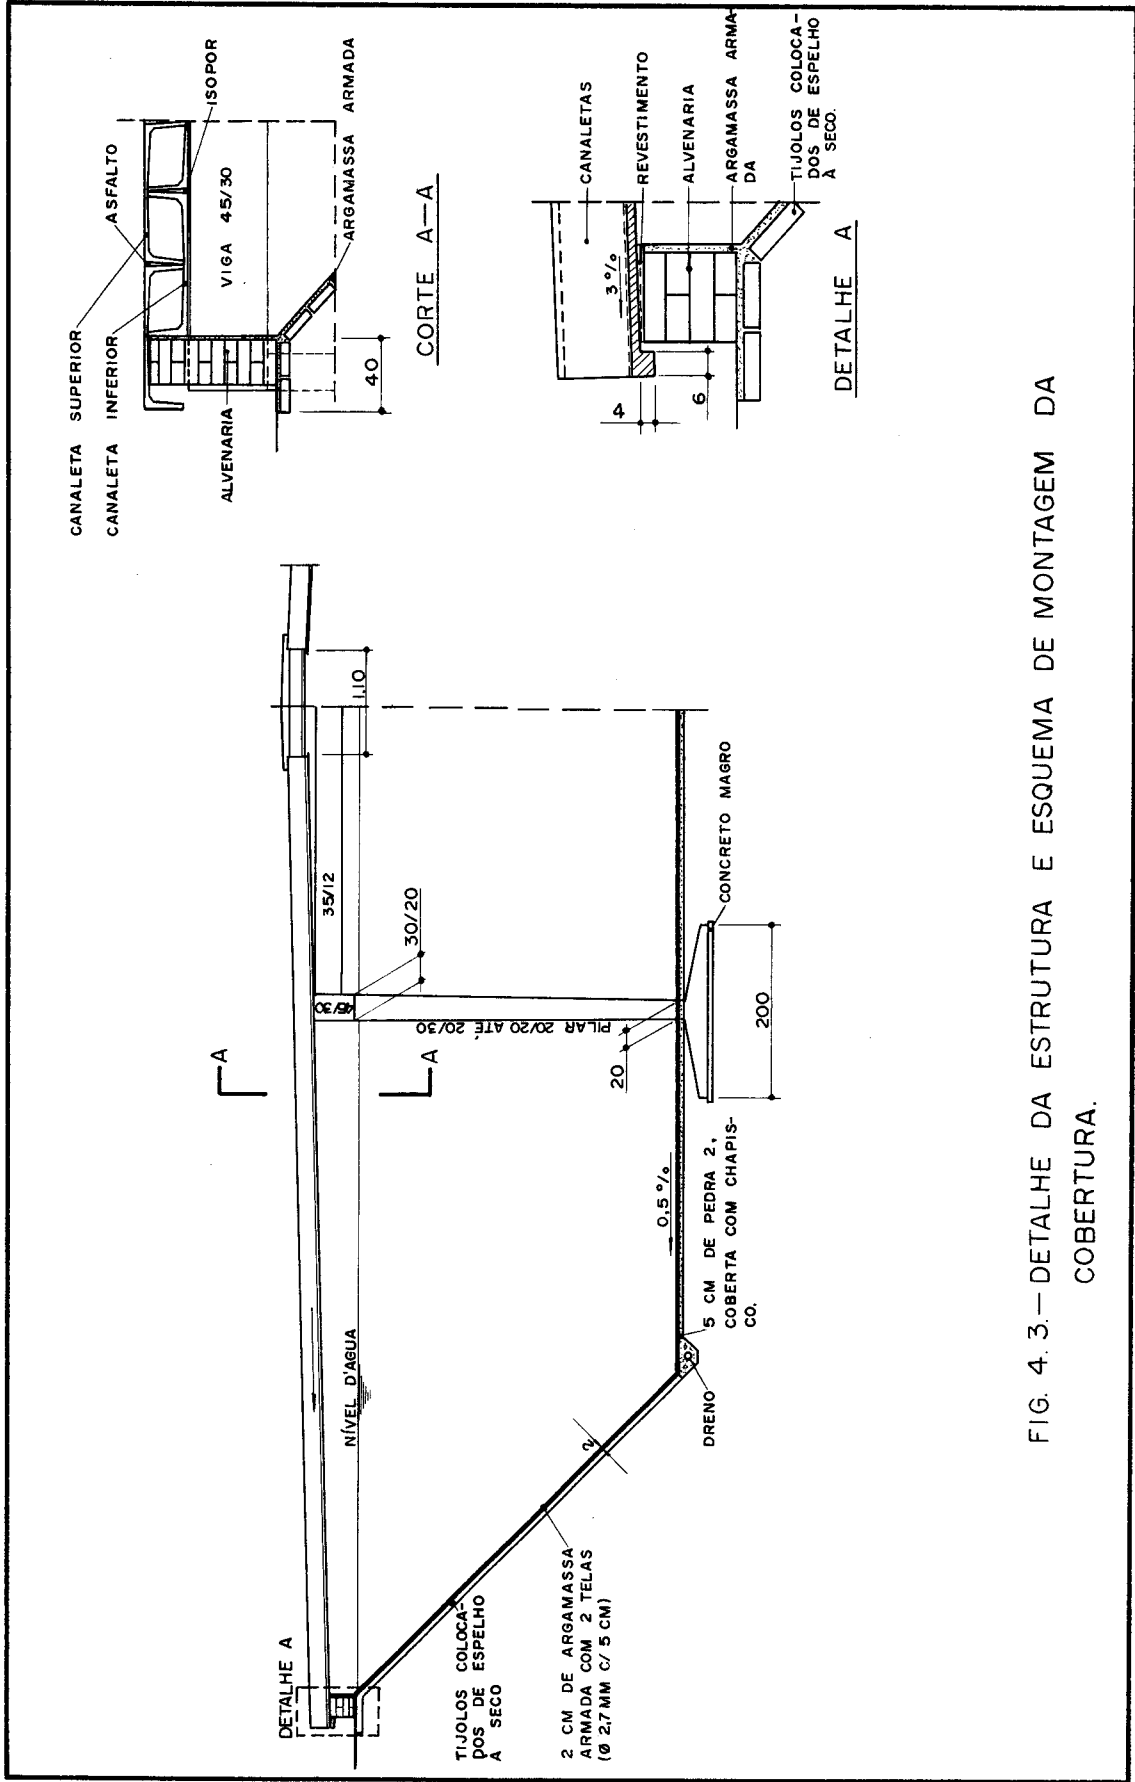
3.—DETALHE DA ESTRUTURA E ESQUEMA DE MONTAGEM DA COBERTURA.
